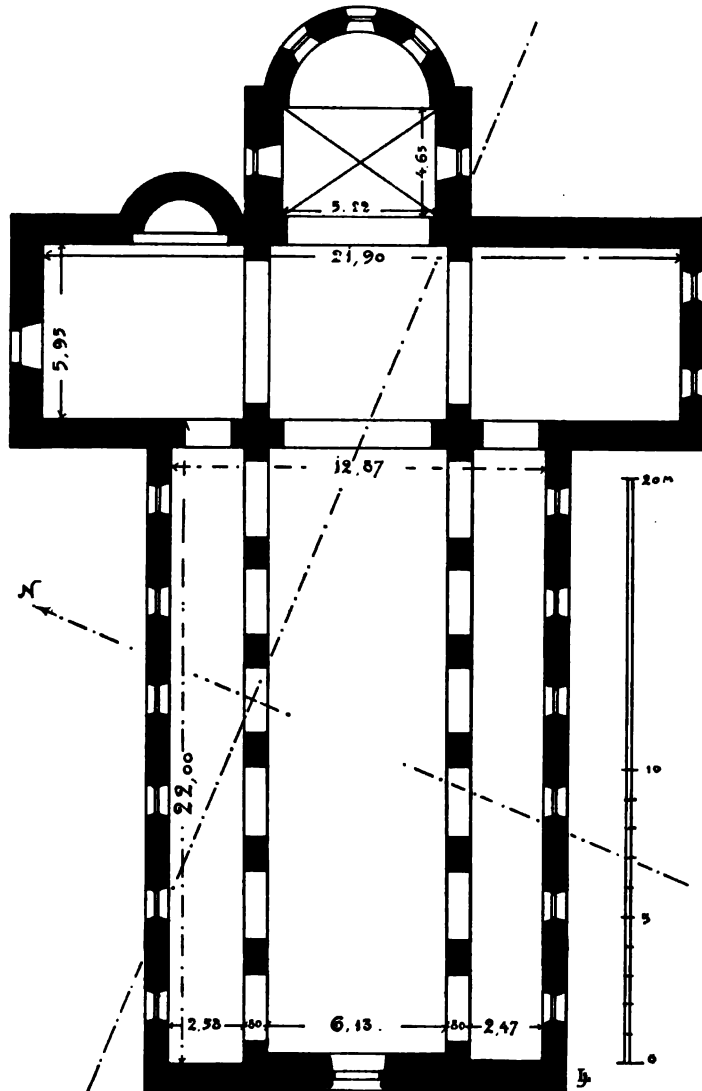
Mittelheim. Pfarrkirche. Grundriss.
